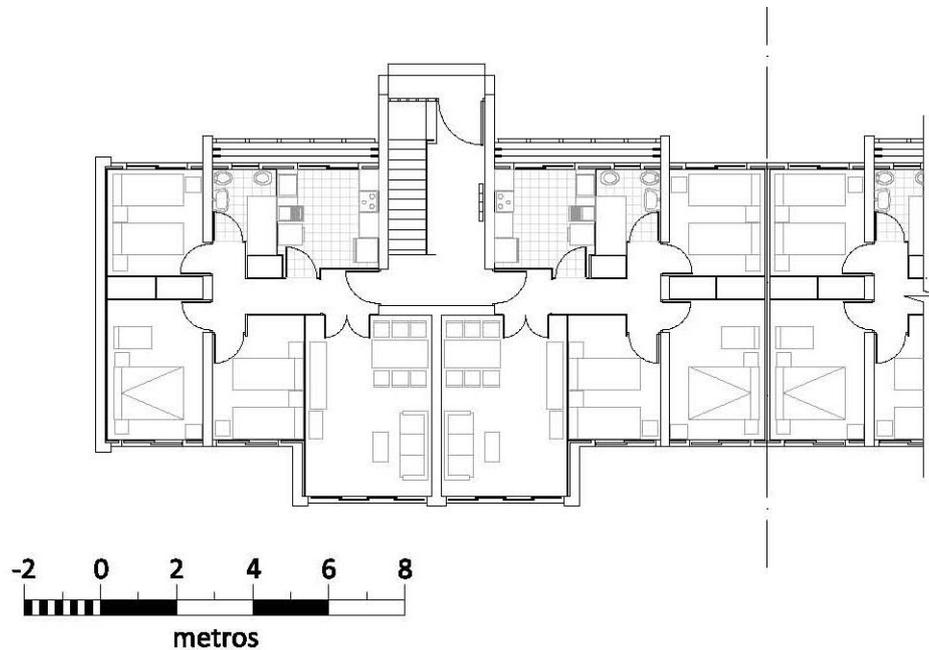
Plano de planta baja escalera 1. Escala 1:200
